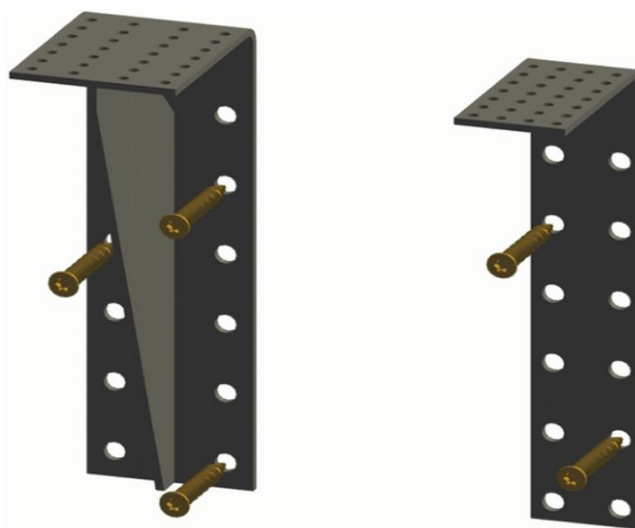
Кронштейны для монтажа в зоне утеплителя опорные
